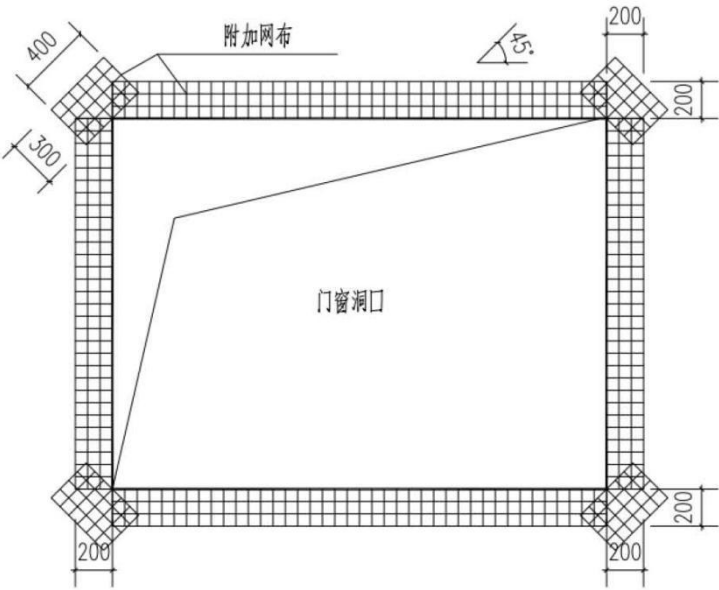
门窗洞口耐碱玻纤网设置示意图
